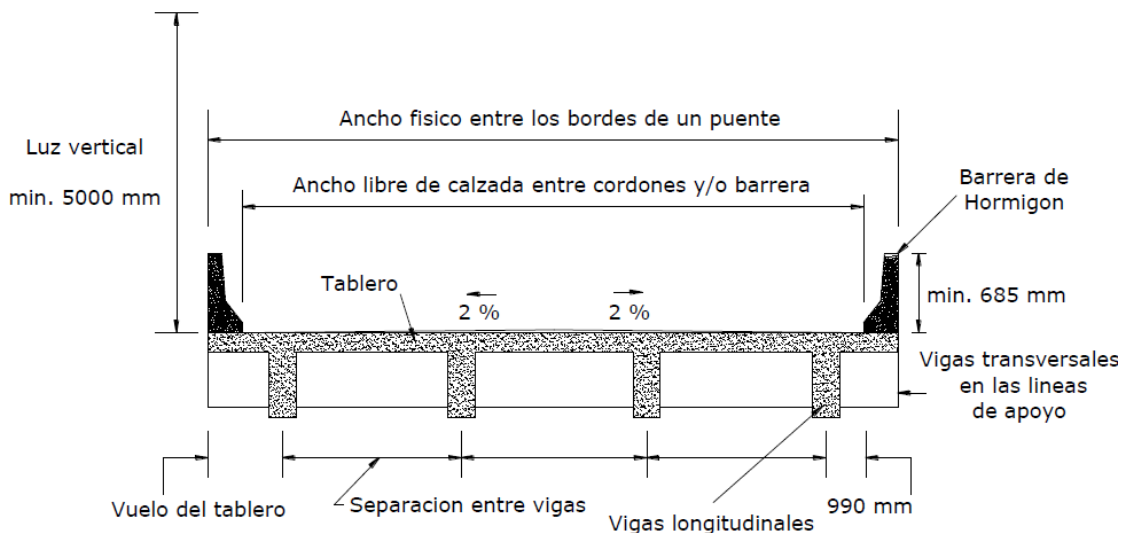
Tablero y estructura portante, puente Viga-Losa.
